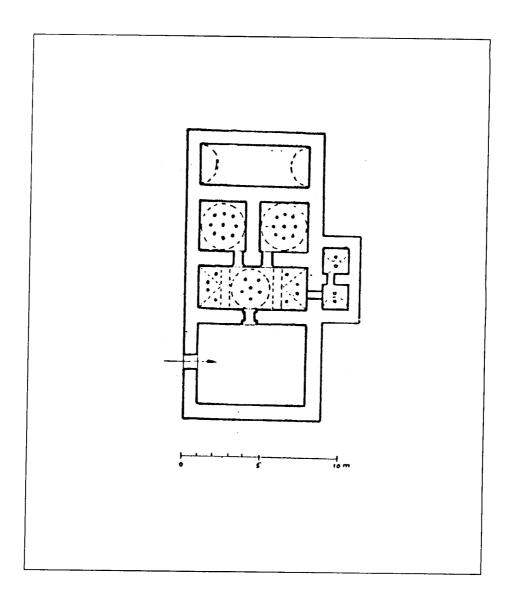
مسقط أفقي لحمام خادم علي باشا في نوفا زاجورا ببلغاريا (عن : كيل) .
